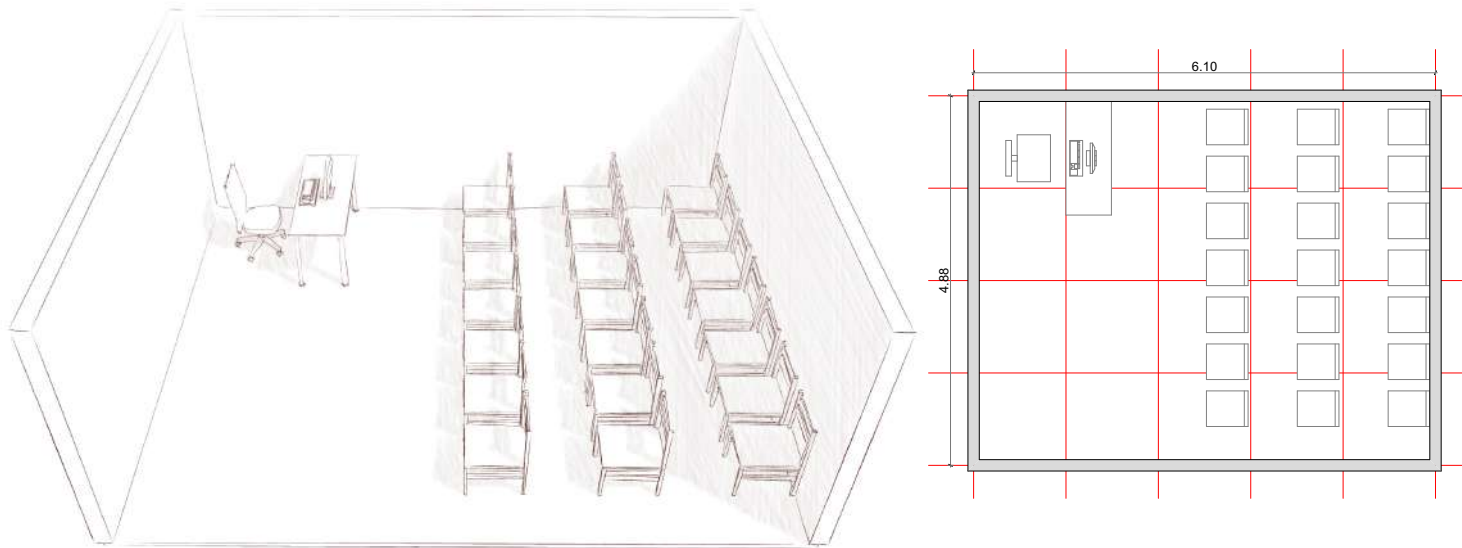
Planta y perspectiva de sala de entrenamiento
